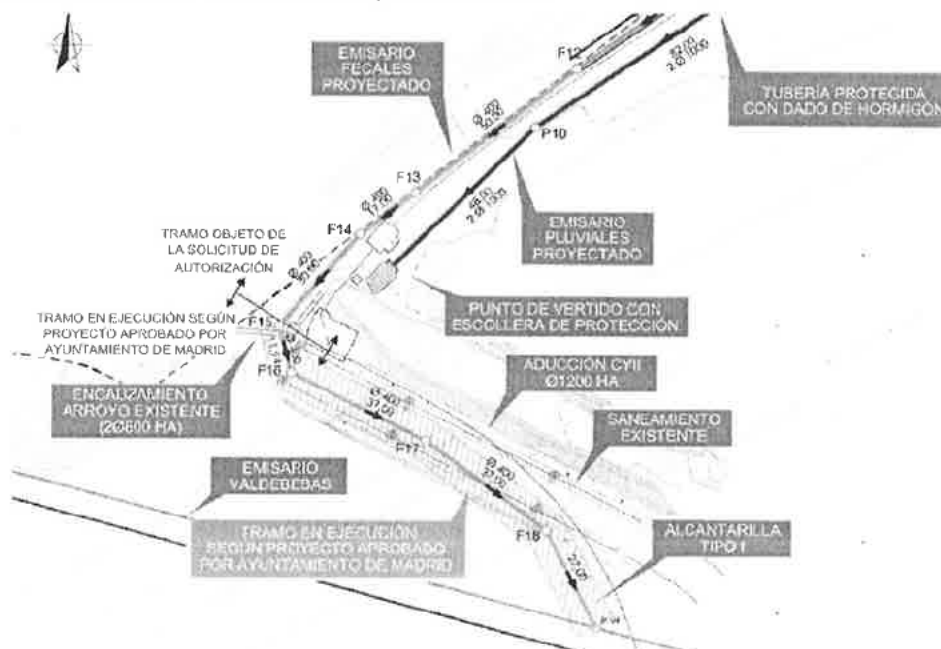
Planta emisarios proyectados. Conexión definitiva.
